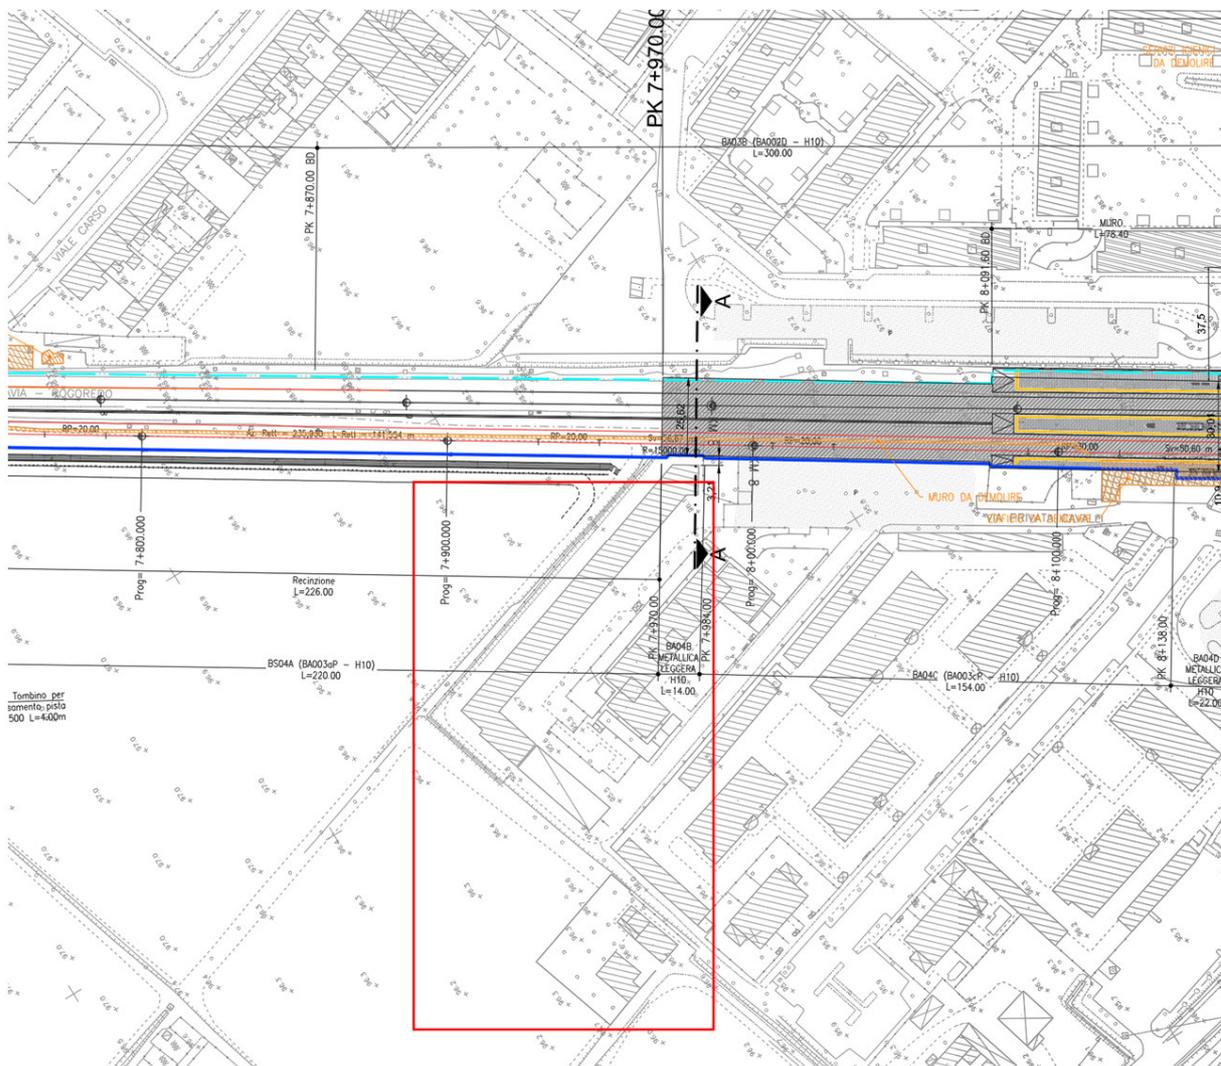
Dettaglio planimetrico zona coperta da barriere antirumore in progetto
